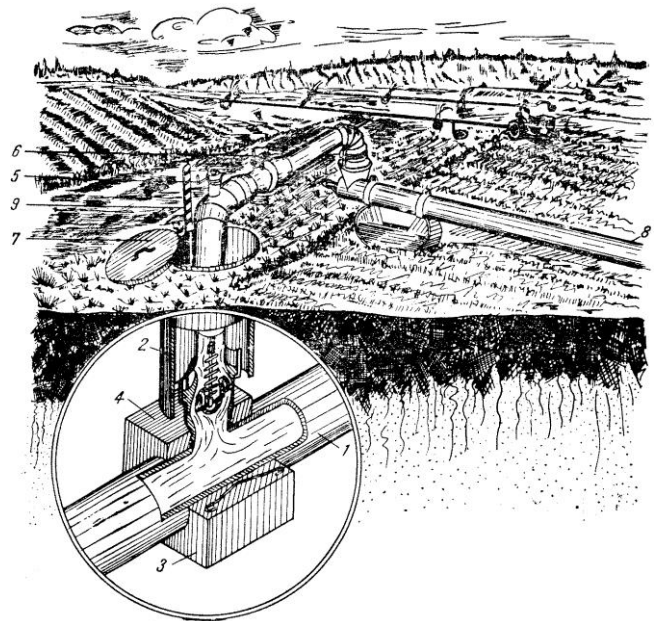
Schema constructivă și funcțională a hidrantului: 1 – conductă subterană; 2 – puț protector; 3, 4 – ancoraj de beton; 5 – robinet cu manivelă de închidere și deschidere a hidrantului; 6 – robinet cu manivelă cu cuplaj rapid; 7 – capacul hidrantului; 8 – aripă aspersoare; 9 – semn de recunoaștere.
